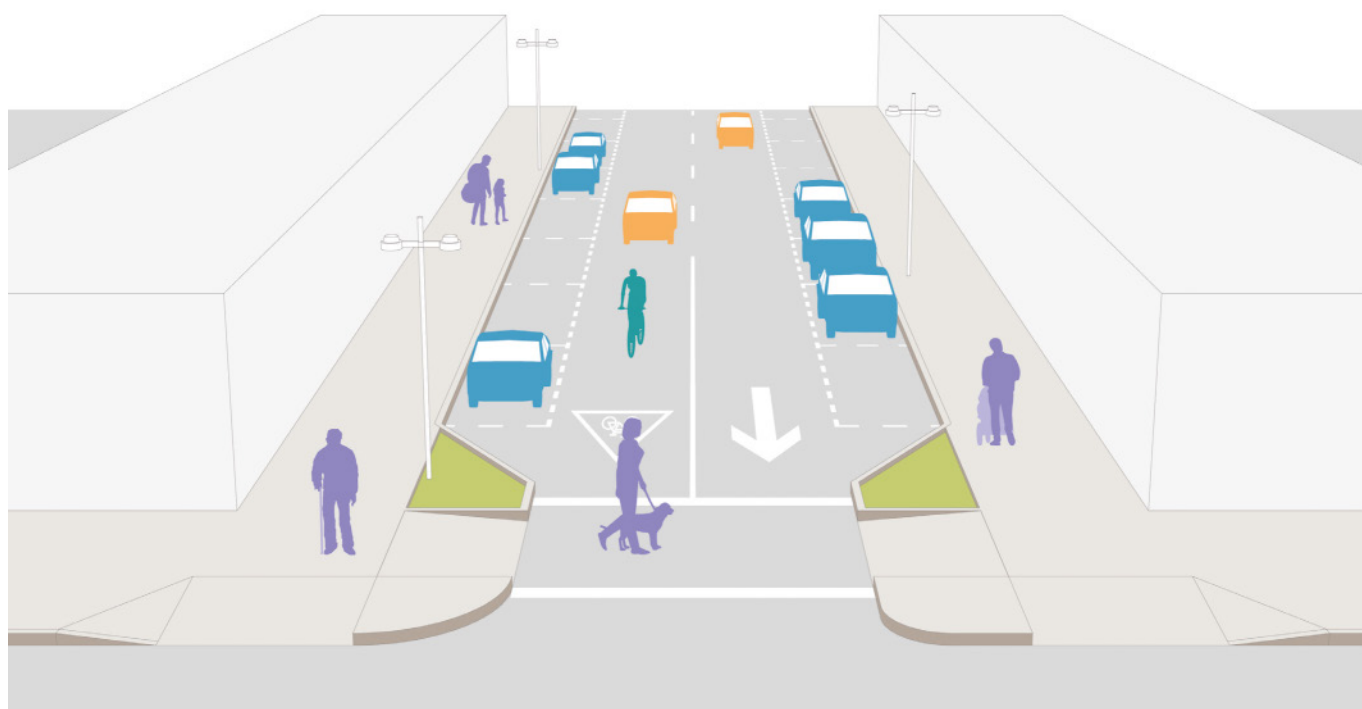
Propuesta de sección para la Calle Restauración. Fuente: elaboración propia.
